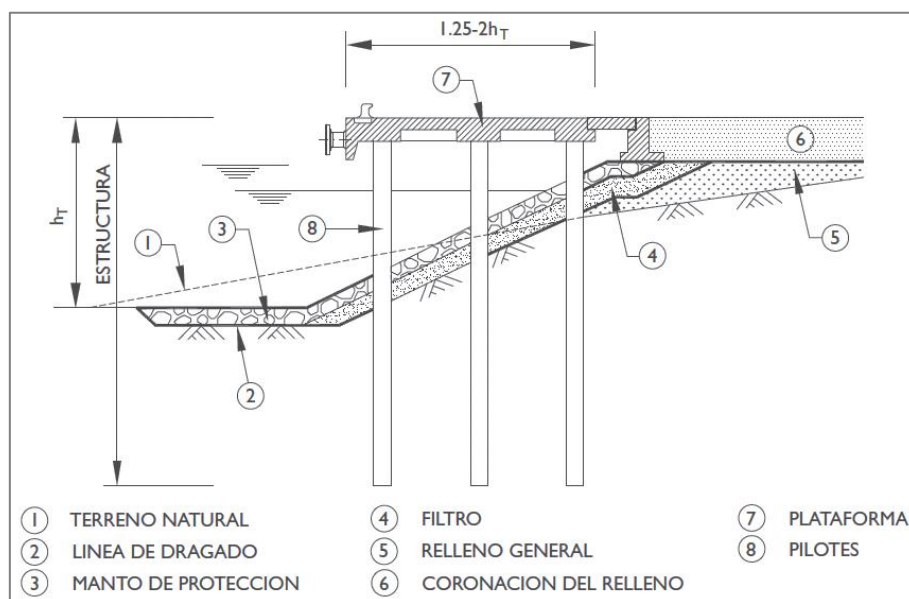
Obra de atraque de pilotes (ROM 2.0-11)
